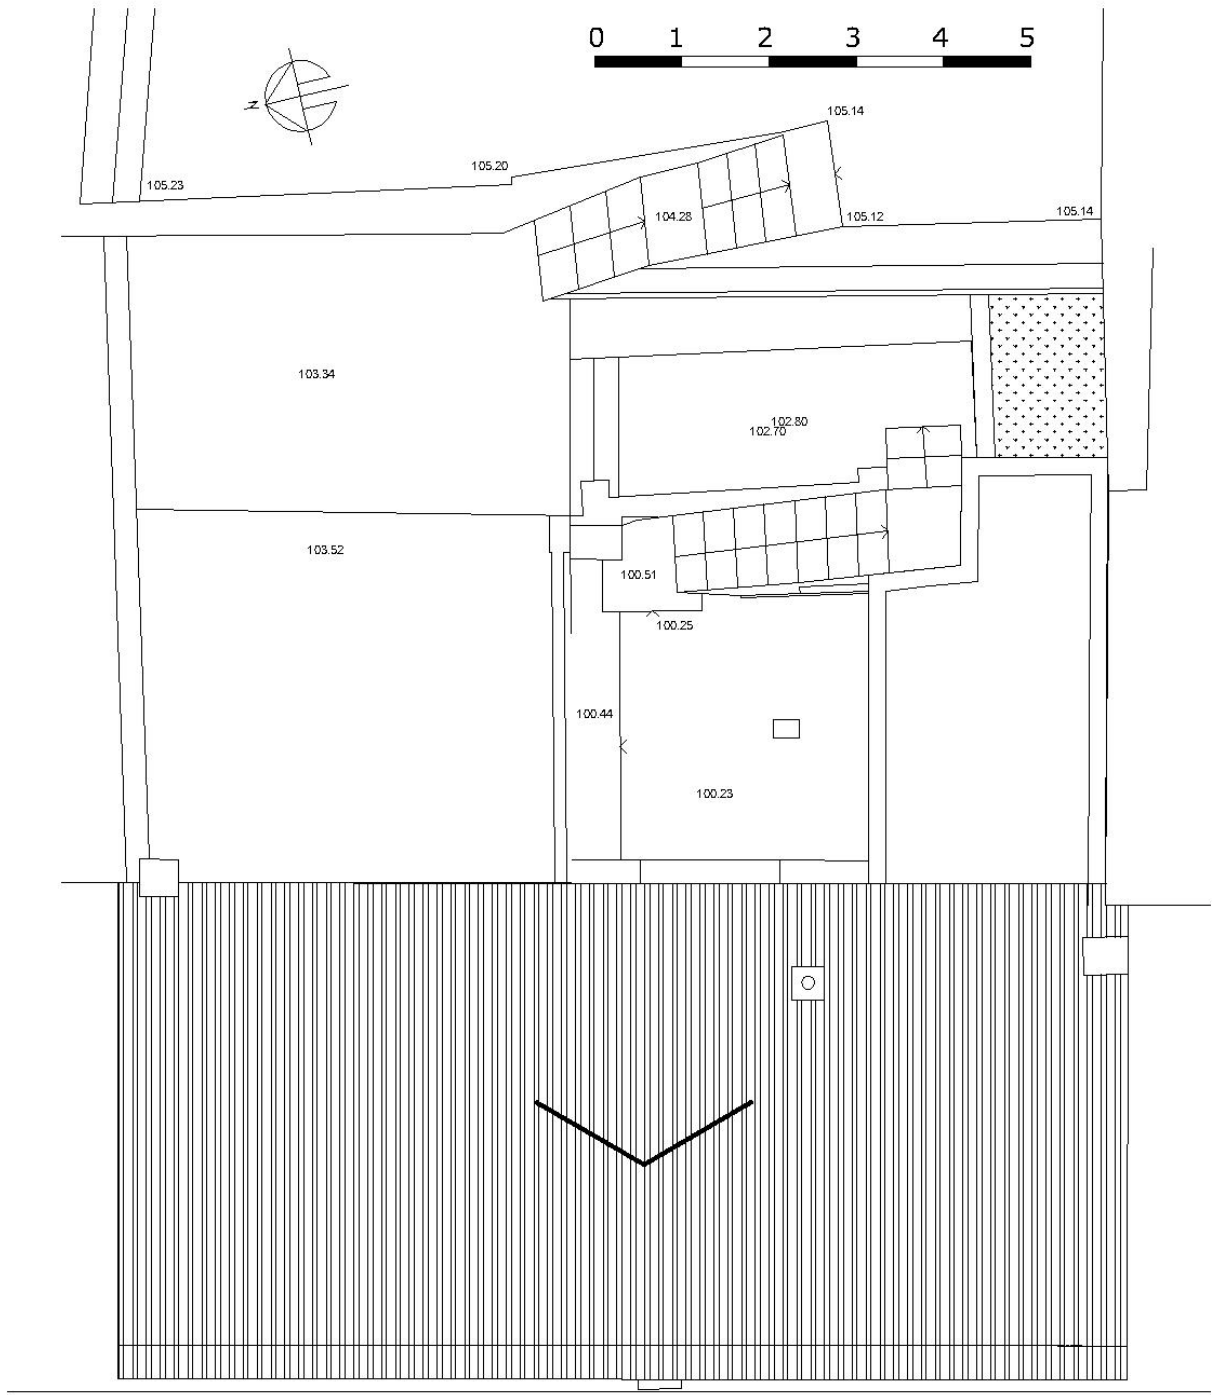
Propuesta de ampliación de la vivienda. Distribución de planta cubierta.
